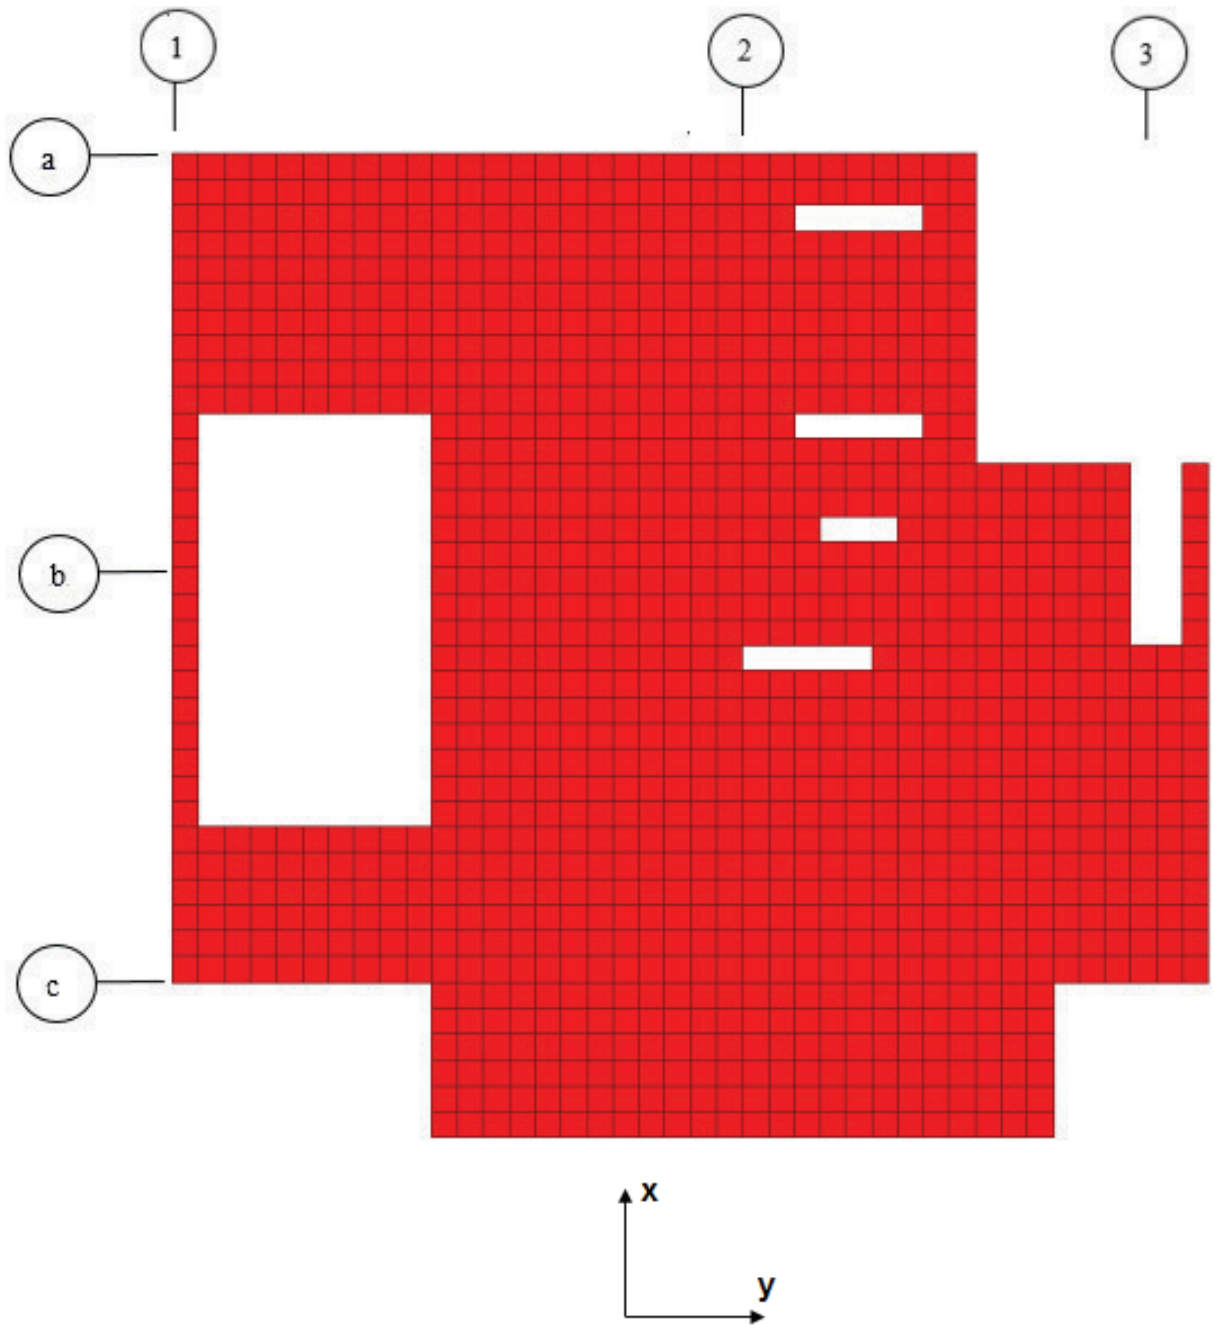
1º Piso – Elevação +6,00 m.
